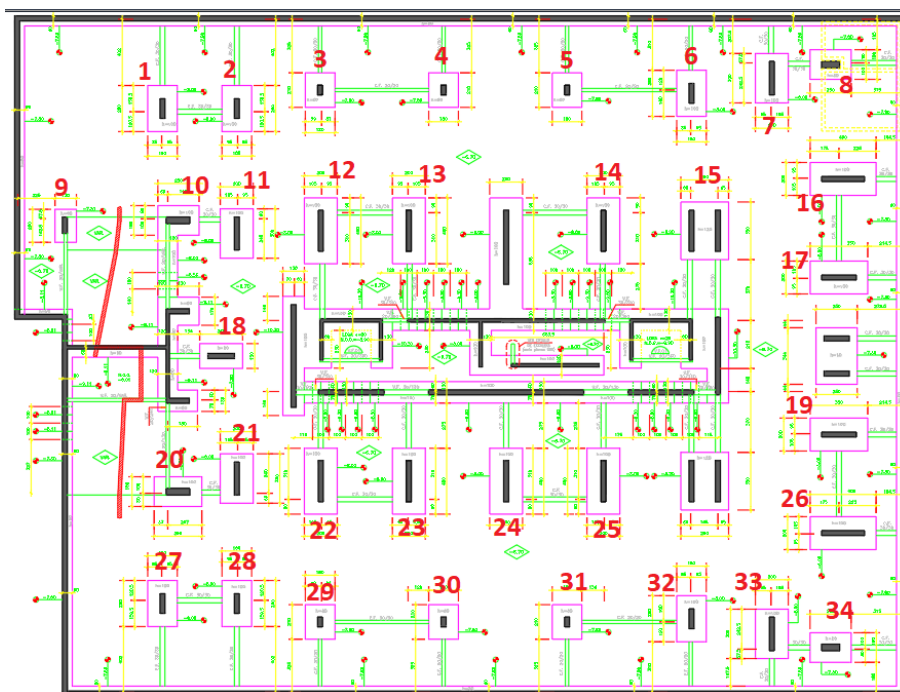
Enumeración de fundaciones en plano Planta de fundaciones, edificio de 6 pisos.
